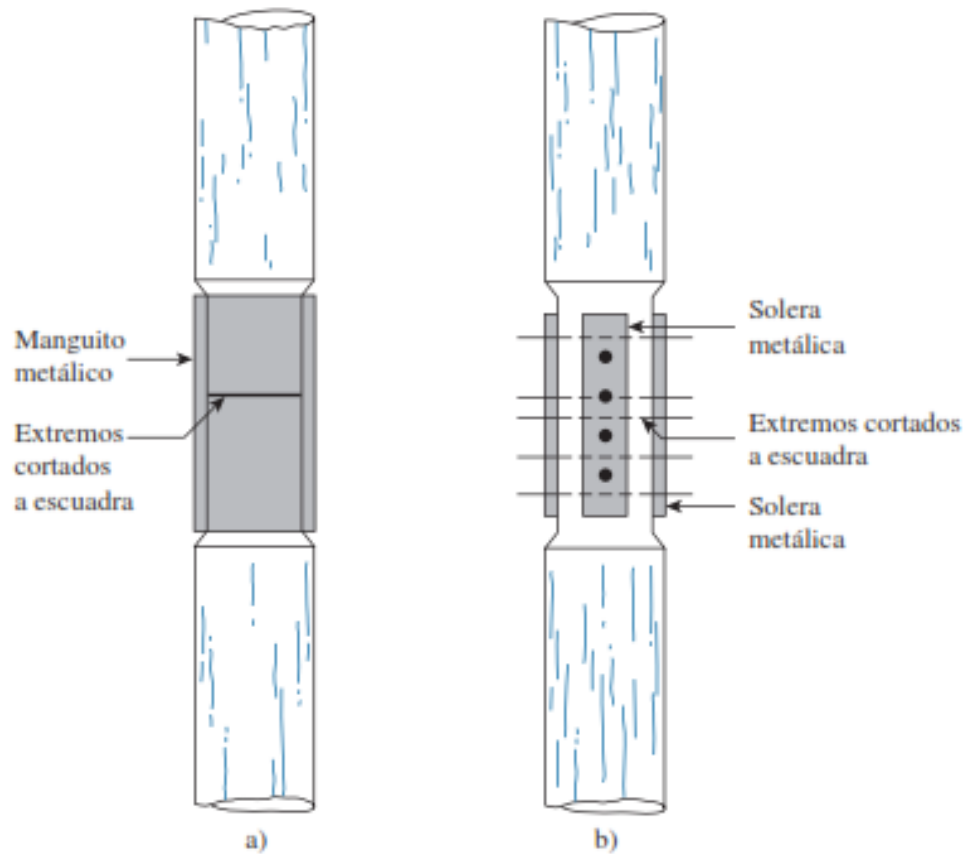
Empalme de pilotes de madera: a) con manguitos tubulares; b) con soleras metálicas y pernos., Adaptado de “Fundamento de ingeniería de cimentaciones”, por Braja M. Das (2012)
